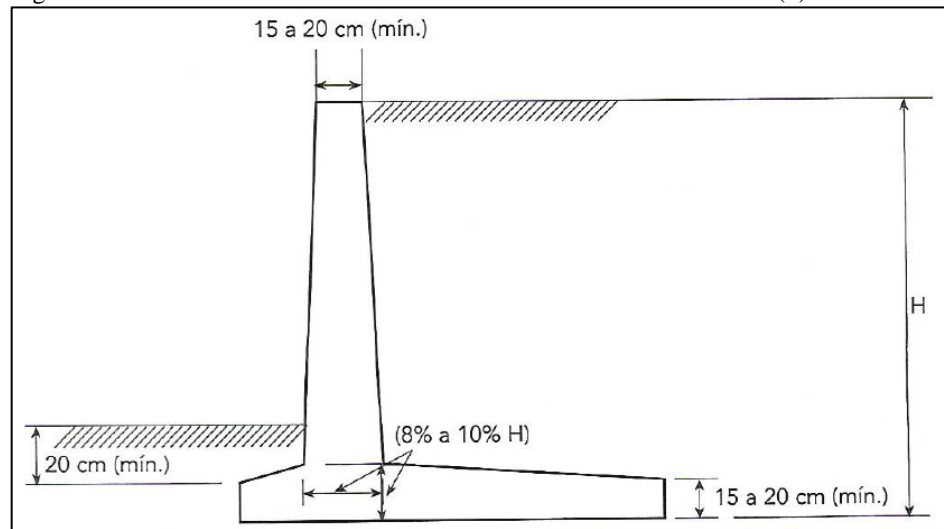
Pré-dimensionamento muro de arrimo em concreto armado (1)
